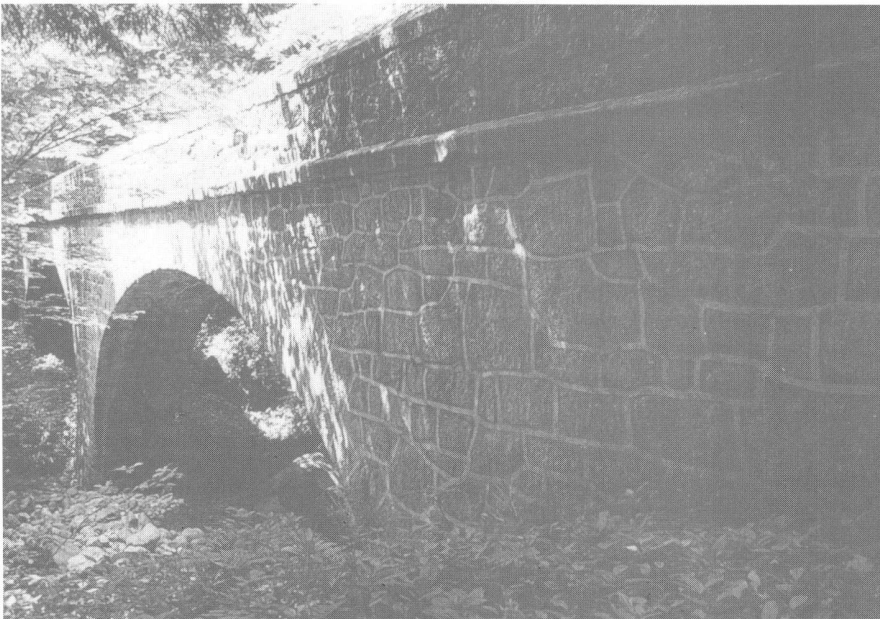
Le Pont de pierre de la conduite des eaux du Pays-d'Enhaut (1901).
